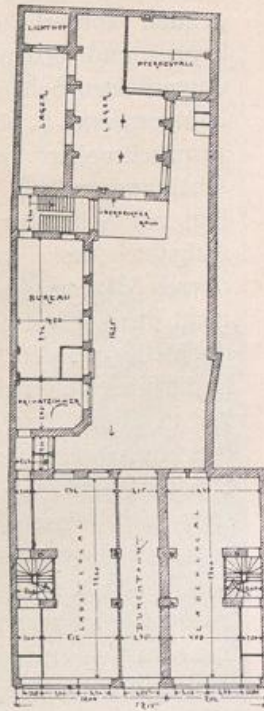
Flingerstrasse 22/26. Erdgeschoss. 1:500.
